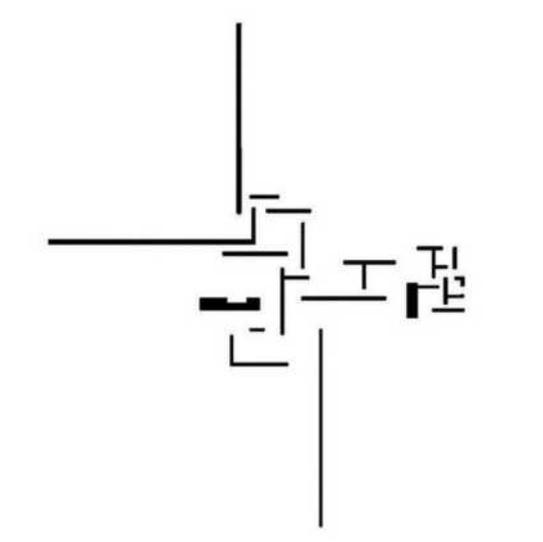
Brick country house, (Mies van der Rohe, 1923).
